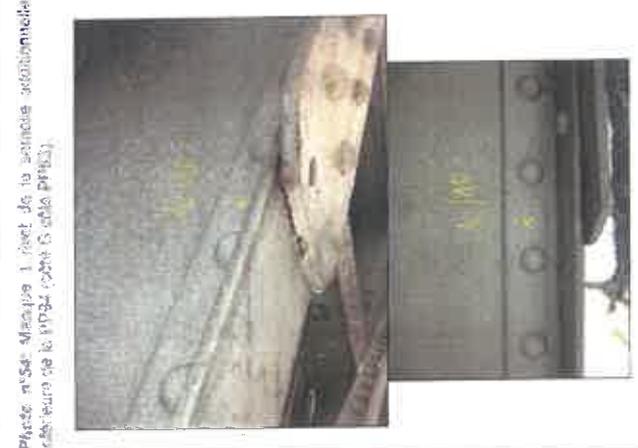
Manques 1 rivet de la section additionnelle sous le feu de la poutre (cote G-024 PPS3)
